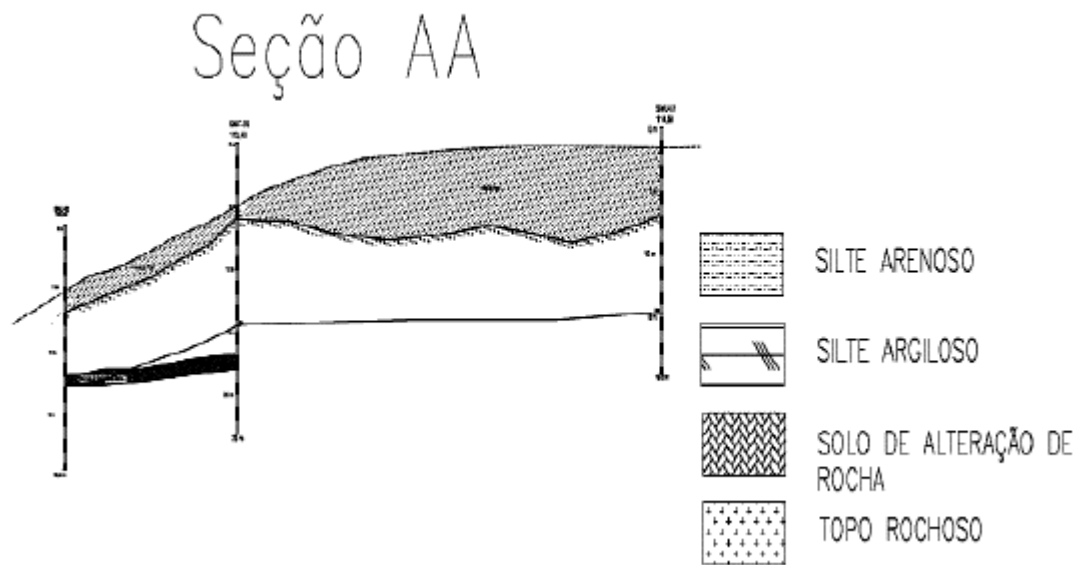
Perfil Geotécnico definido pelas Sondagens Mistas – Seção “AA”.
